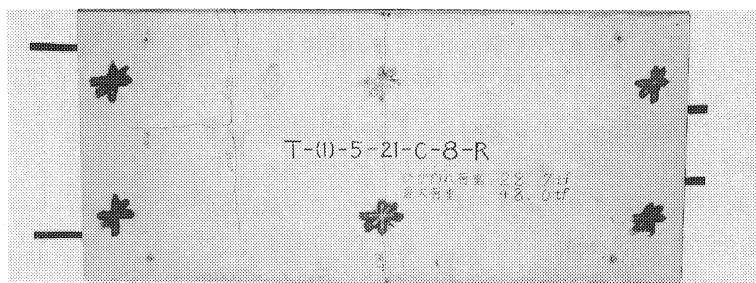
ひび割れ発生状況(PC鋼材直角方向)
